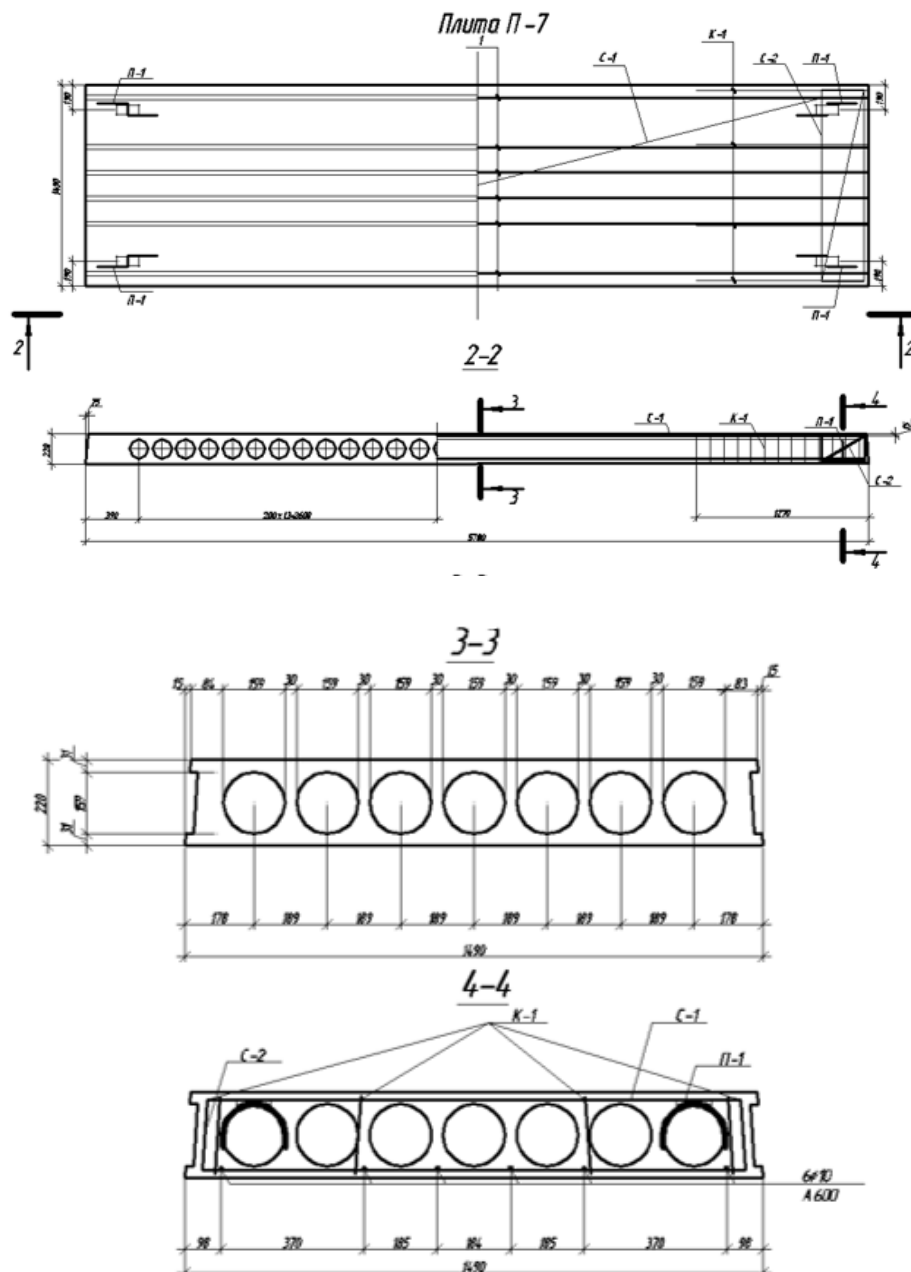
Опалубка плиты П-1 и схема армирования
